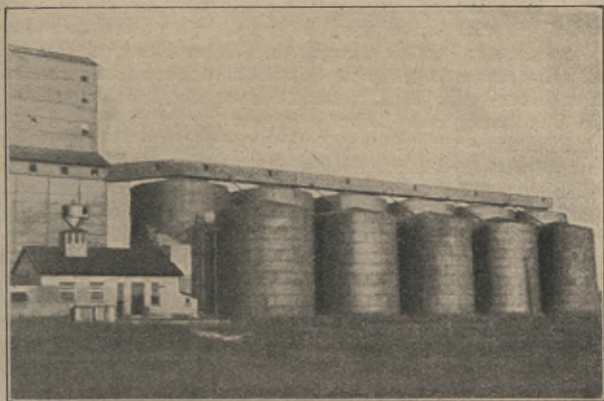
Stahlsilo der Pioneer Steel Elevator Co. in Minneapolis. (Aus Zt. „Mühlen- und Speicherbau“.)
